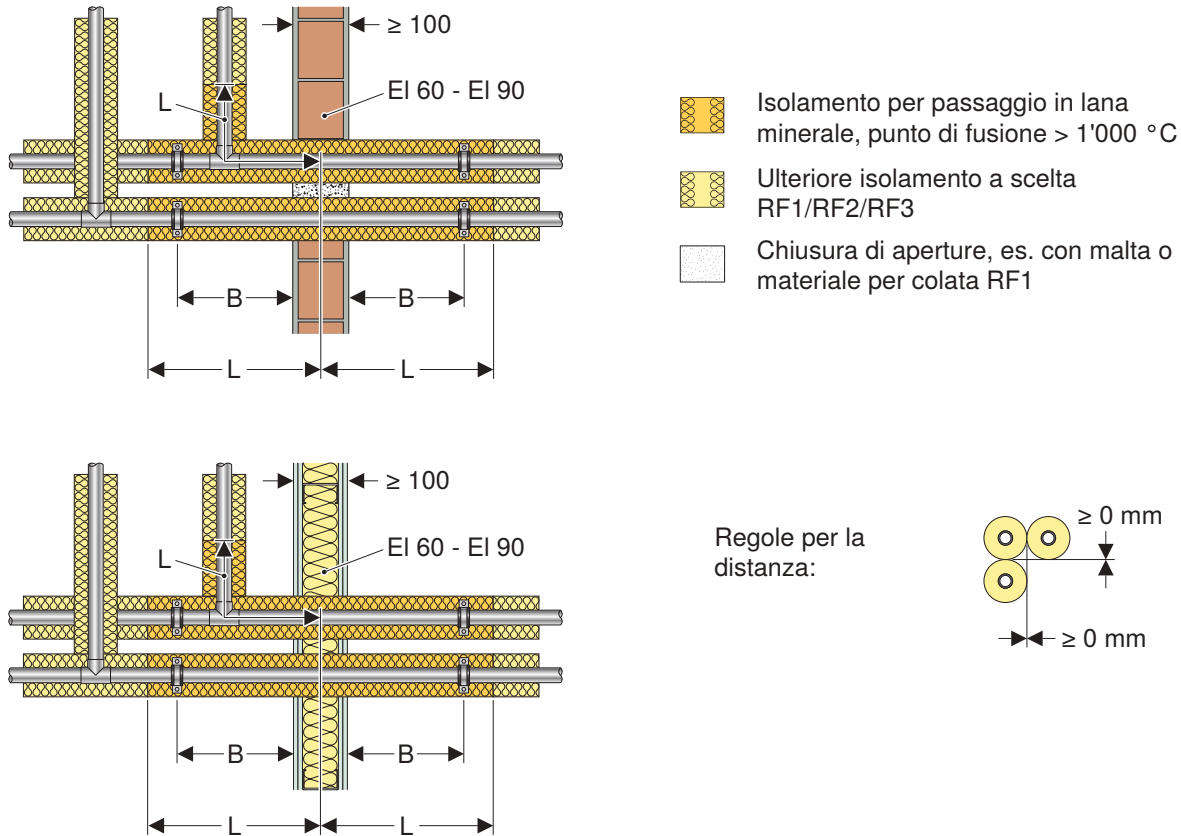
Passaggio per tubi in parete in muratura o parete leggera con isolamento Geberit Mepla o Geberit PushFit e Rockwool 800
